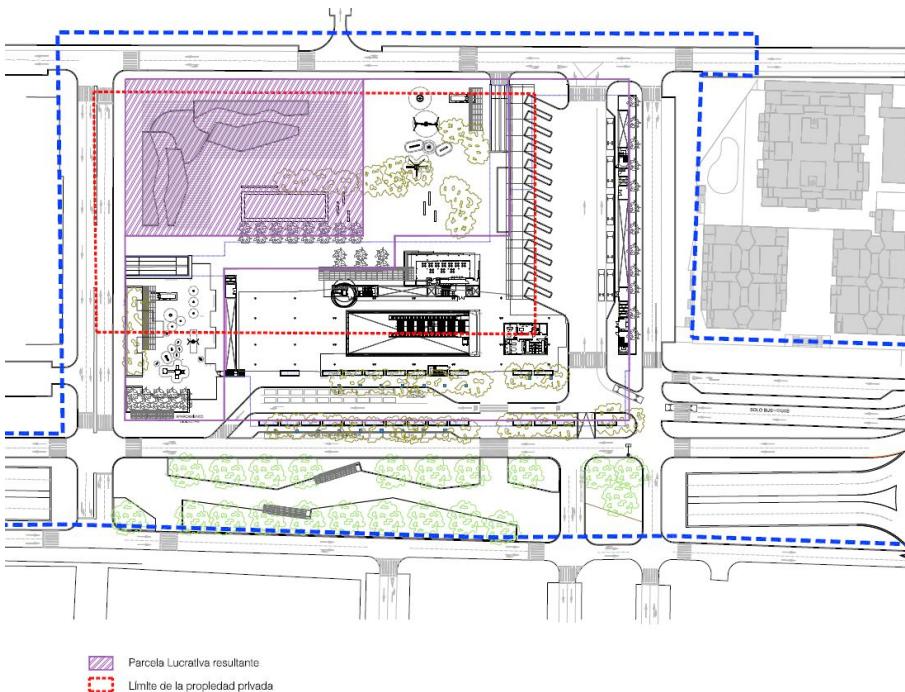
Planta Superficie Proyecto Constructivo Intercambiador de Los Cristianos indicando el ámbito de actuación de la operación urbanística en trazo discontinuo azul
